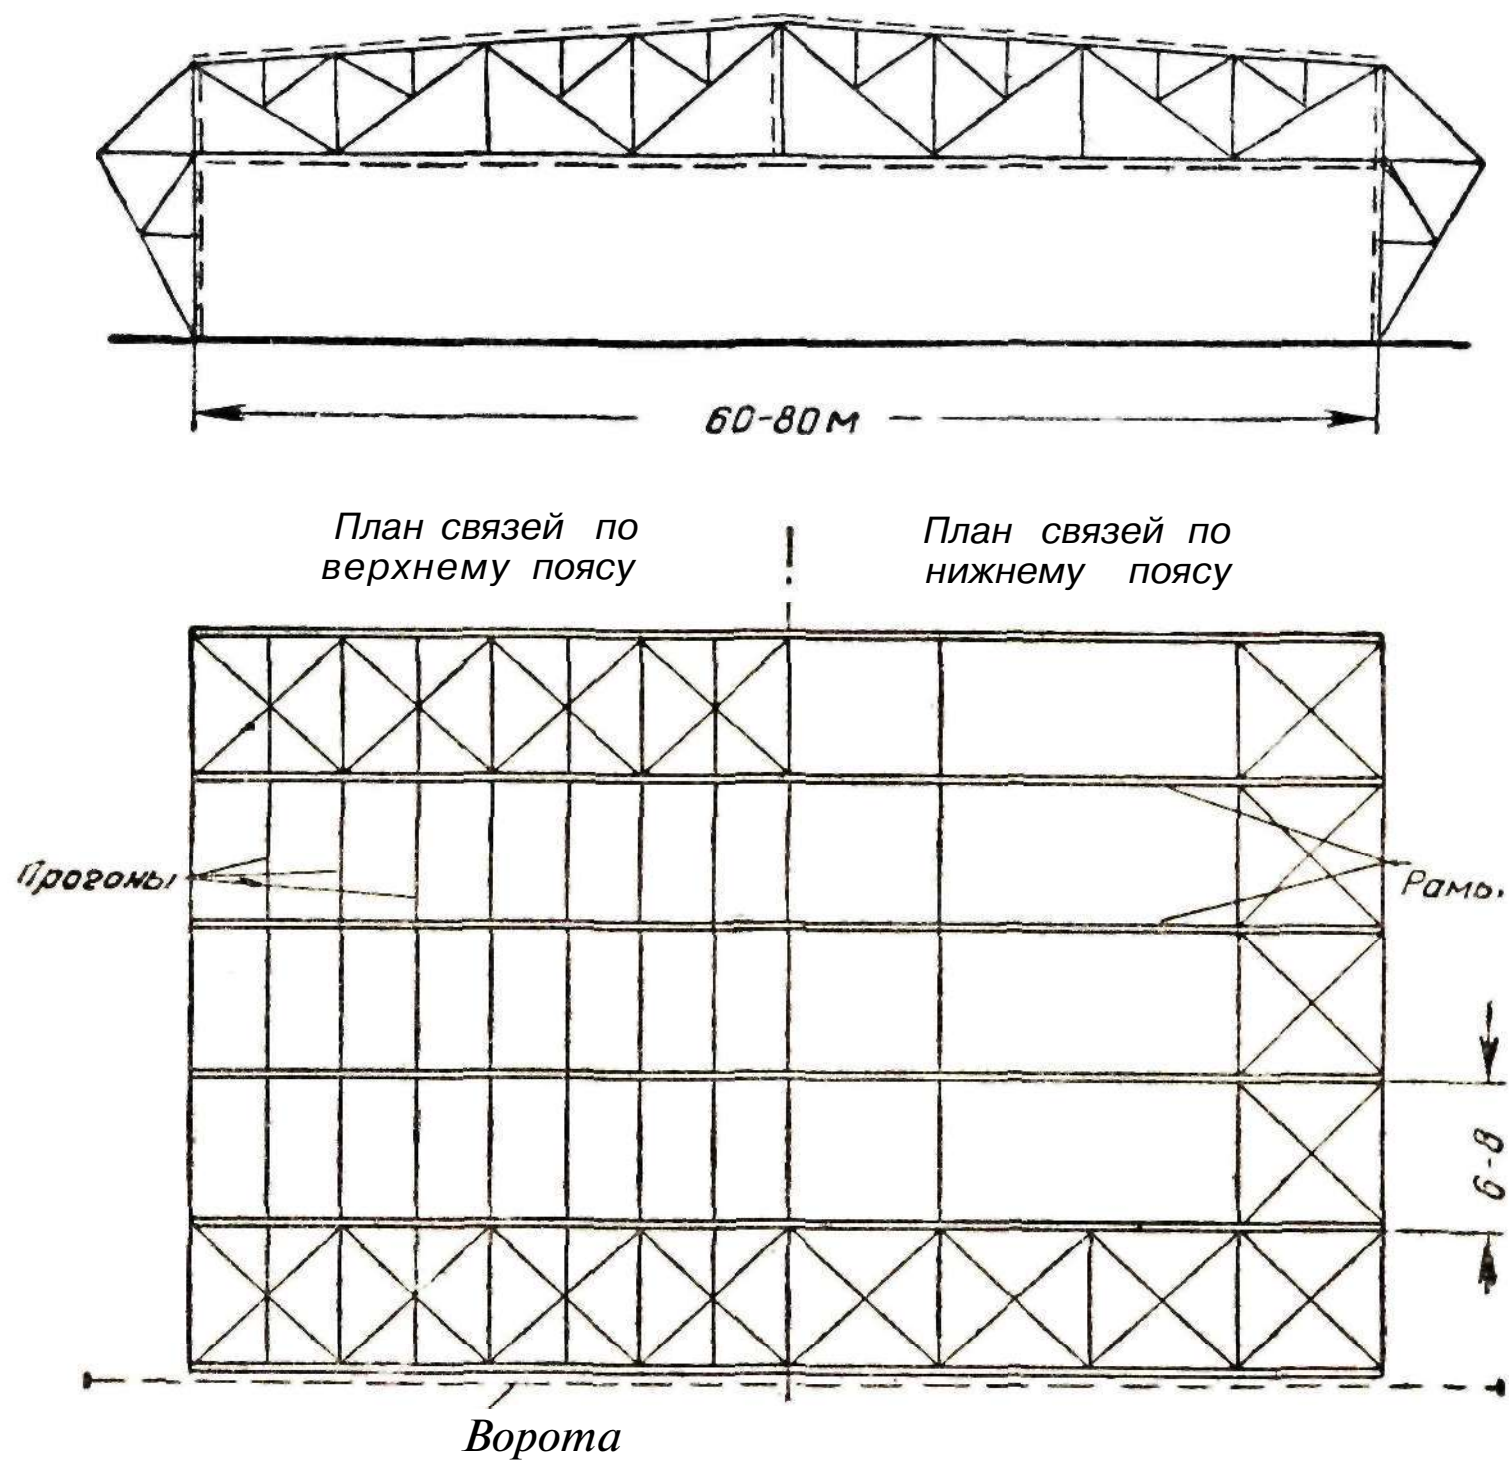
Поперечная планировка перекрытия ангара
